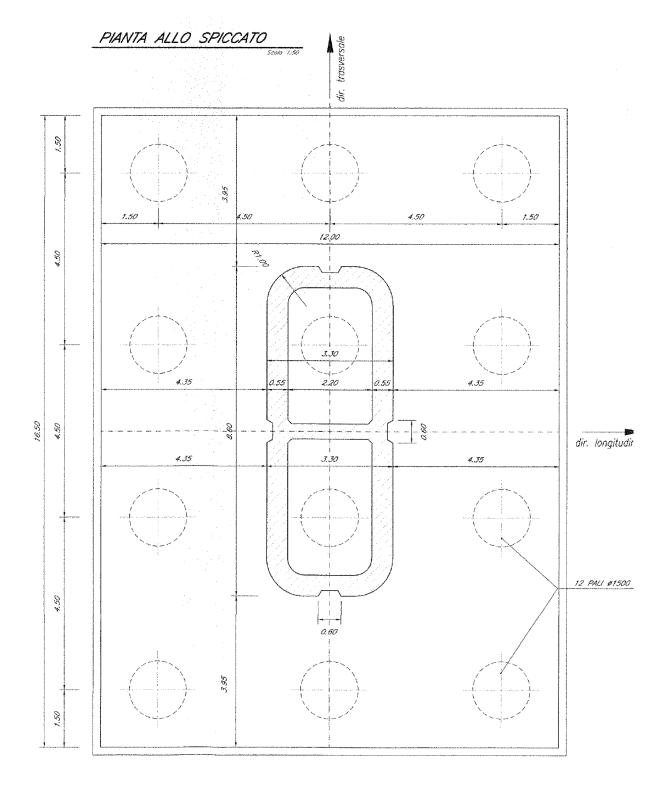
Plinto di fondazione e pali, vista in pianta - Sezione del fusto pila [m]
